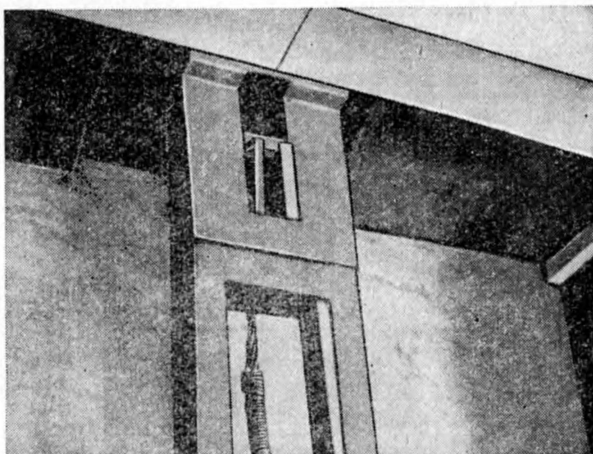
Головка стойки с упрощенным креплением клиньями в верхнем положении
